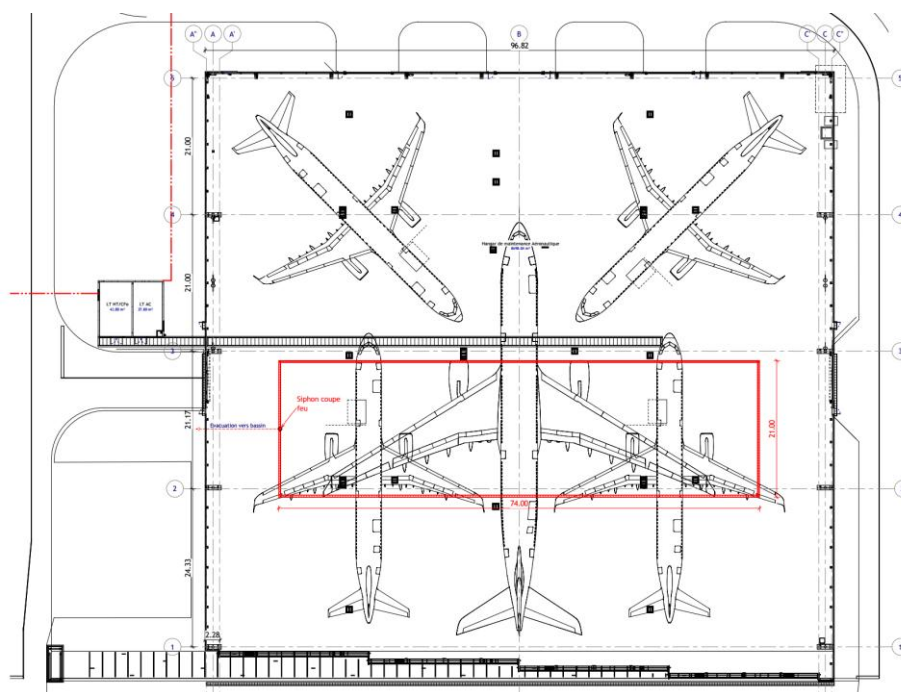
extrait du plan n°18_010_Aéroport Châteauroux - HA - AR111 Plan Hall avec Caniveau disponible en pièce jointe n°19
